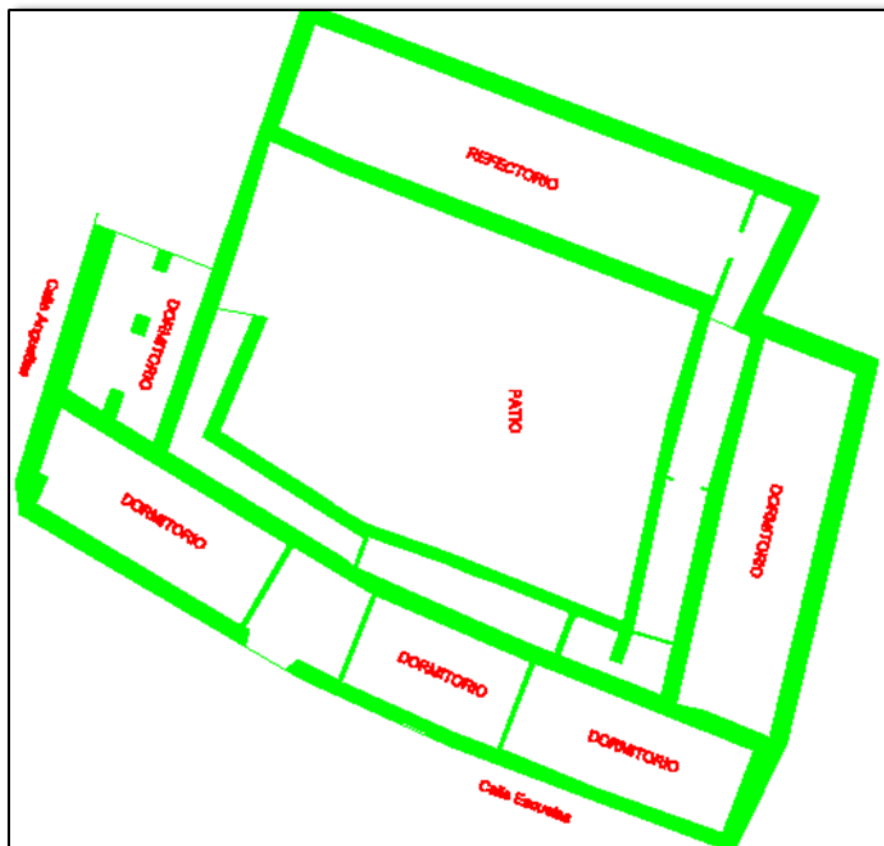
Planta alta de la Casa Palop. Elaboración propia.
